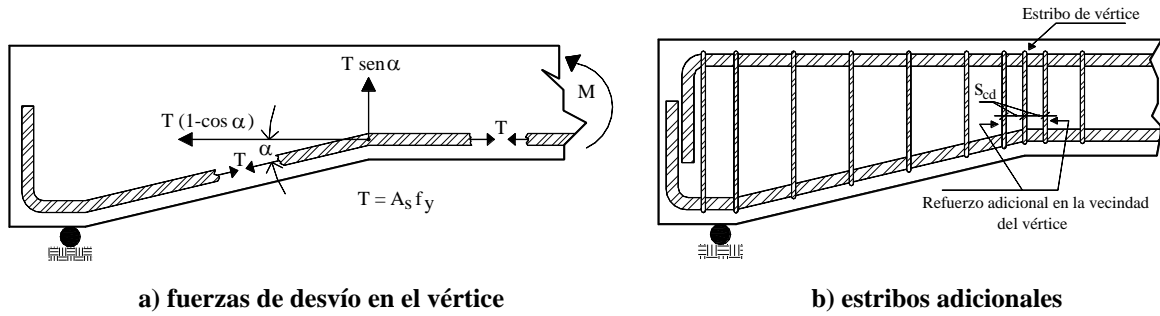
Refuerzo adicional debido al cambio de dirección del refuerzo longitudinal inclinado
